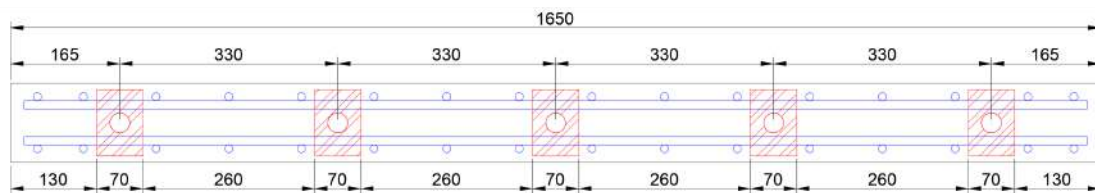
Sección donde se pueden apreciar las placas de anclaje (mm)
